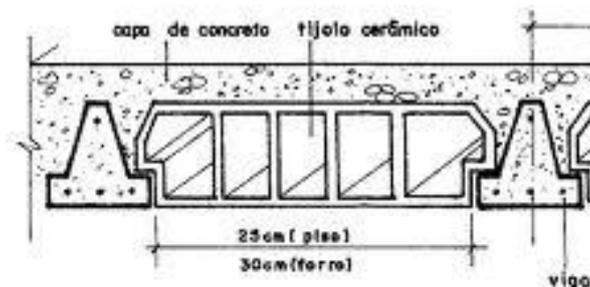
Elementos da laje pré-moldada comum, podendo o bloco ser cerâmico, de concreto ou de EPS (Isopor).
